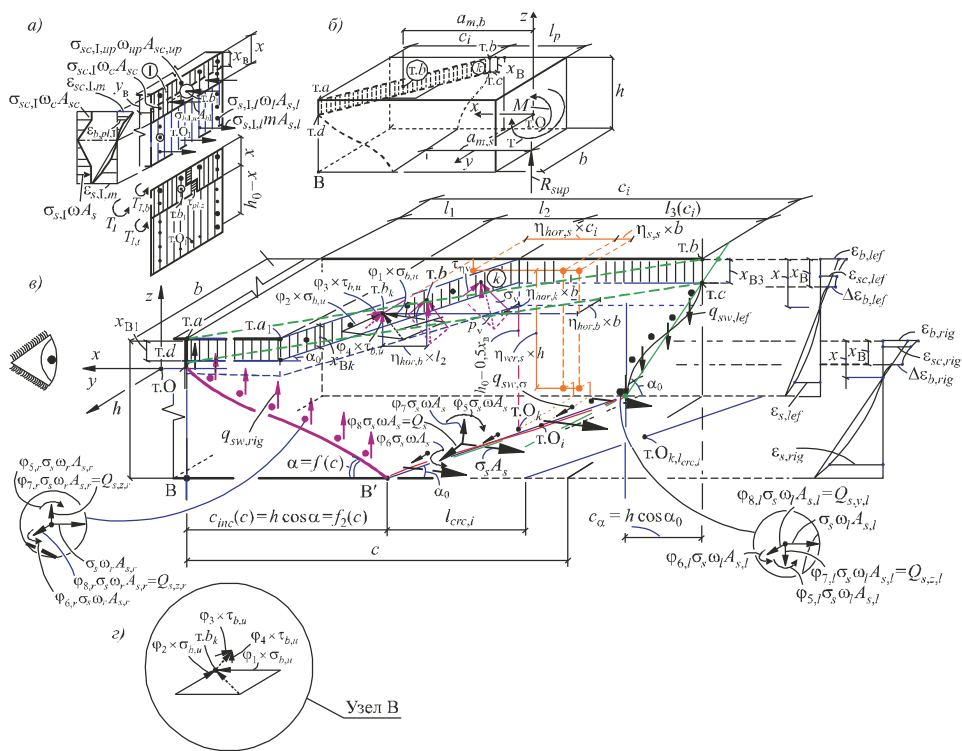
Расчетная схема А сопротивления железобетонной конструкции при совместном действии изгибающего и крутящего моментов и поперечной силы в пространственной трещине
